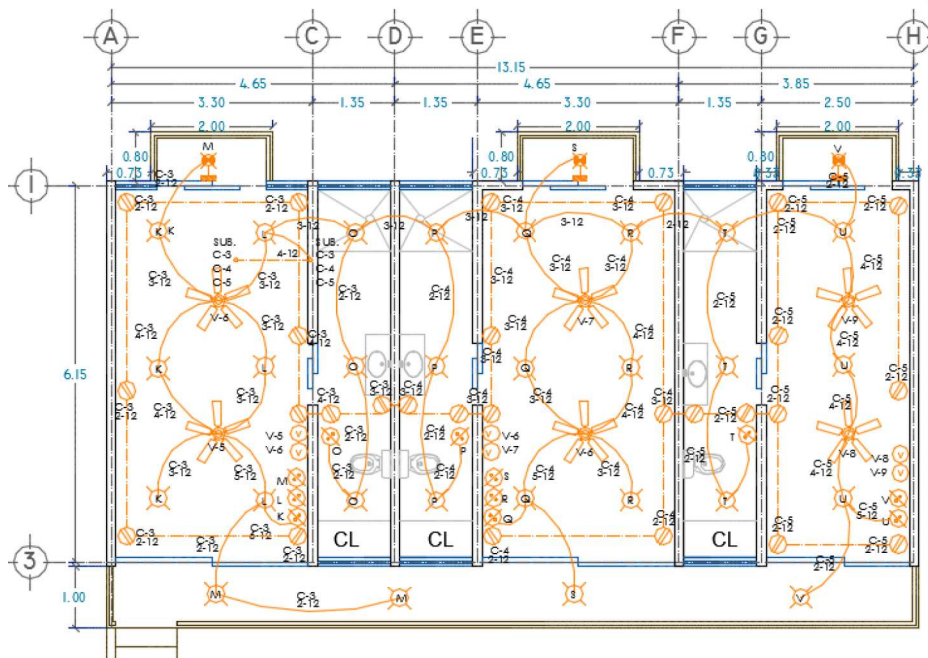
Instalación eléctrica, planta alta. Casa de Veraneo (Retiros).
